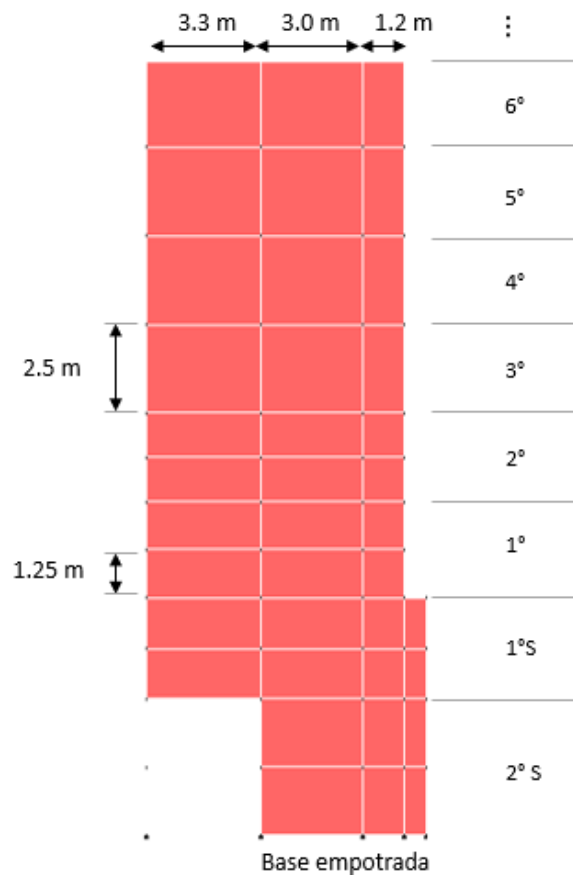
Mallado muro eje 7 en modelo simplificado de ETABS.
